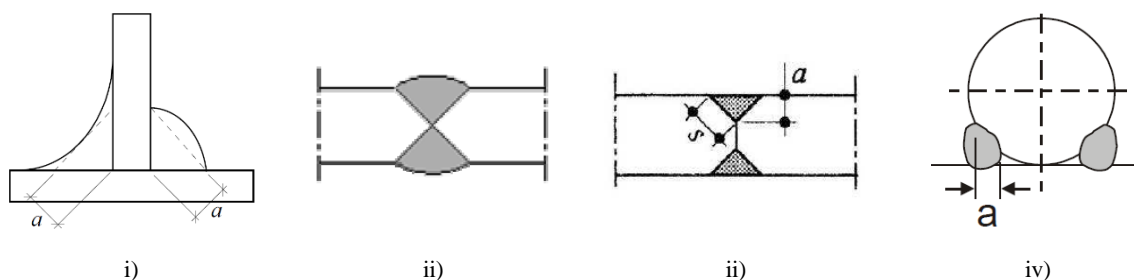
Exemplos de alguns tipos de soldadura [8] abrangidos pelo EC3: Parte 1-8.
